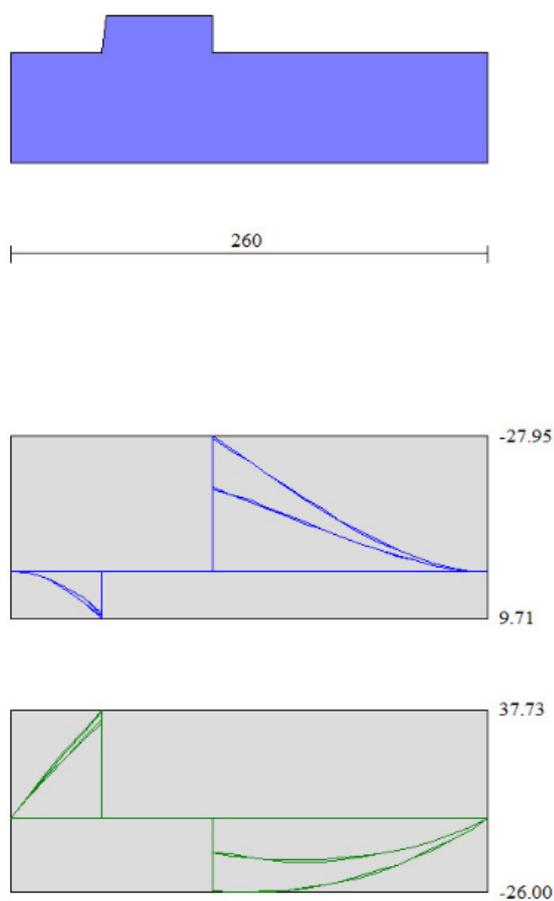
Involuppo delle sollecitazioni SLU e SLV sulla ciabatta di fondazione
